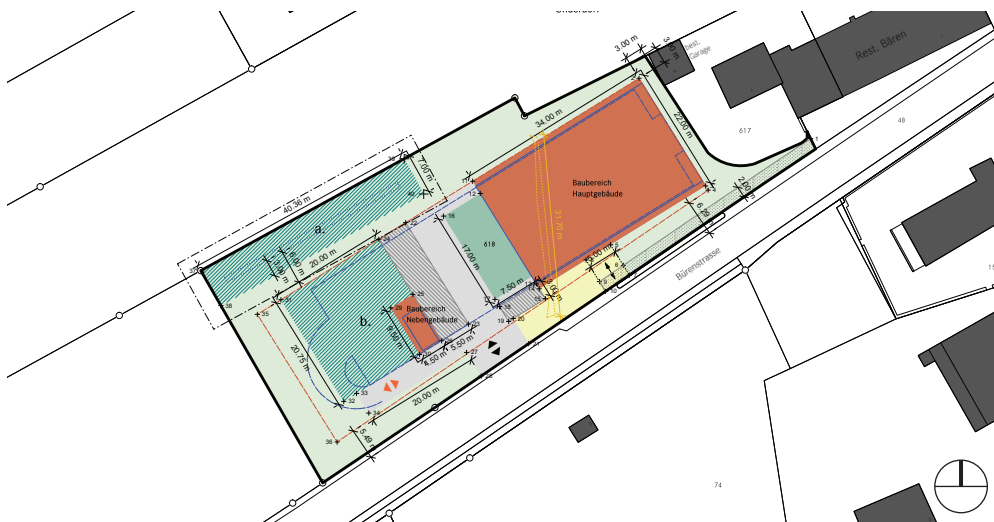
Auszug Überbauungsplan (freier Massstab)
